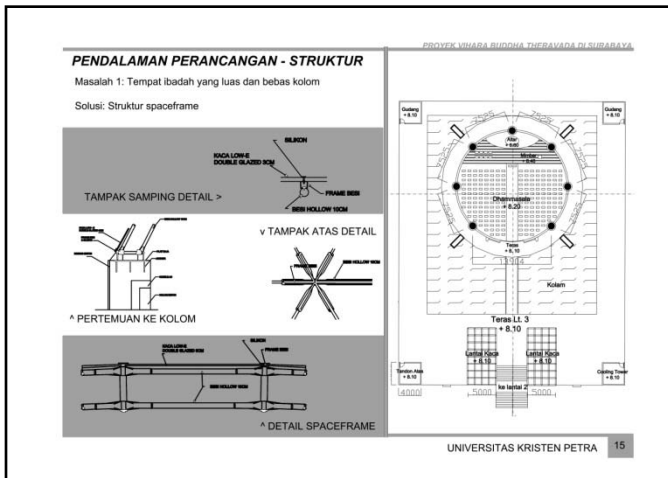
Utilitas Air Bersih, Utilitas AC, dan Sistem Struktur
